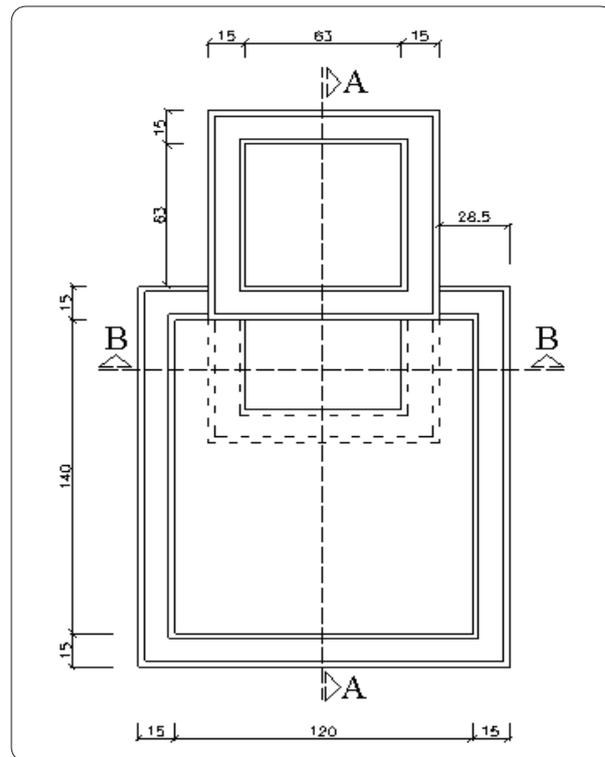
Planta do filtro no nível 2 m (cotas em cm).
